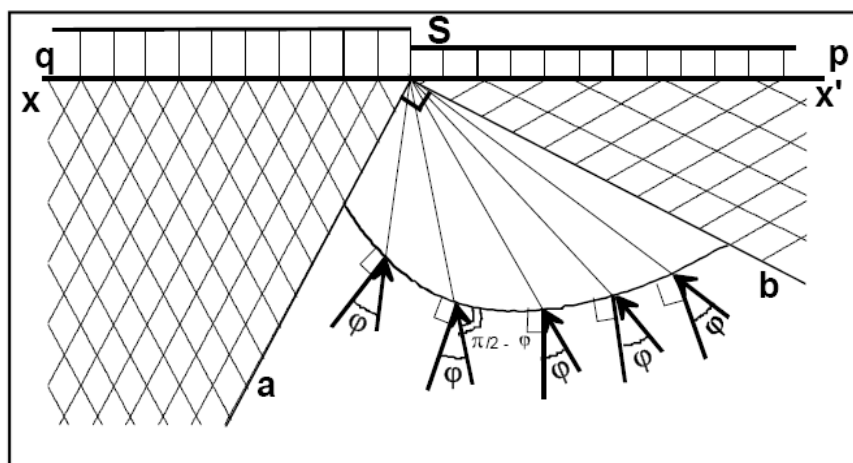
Mécanisme de rupture d'une fondation de base lisse (Prandtl 1920)
